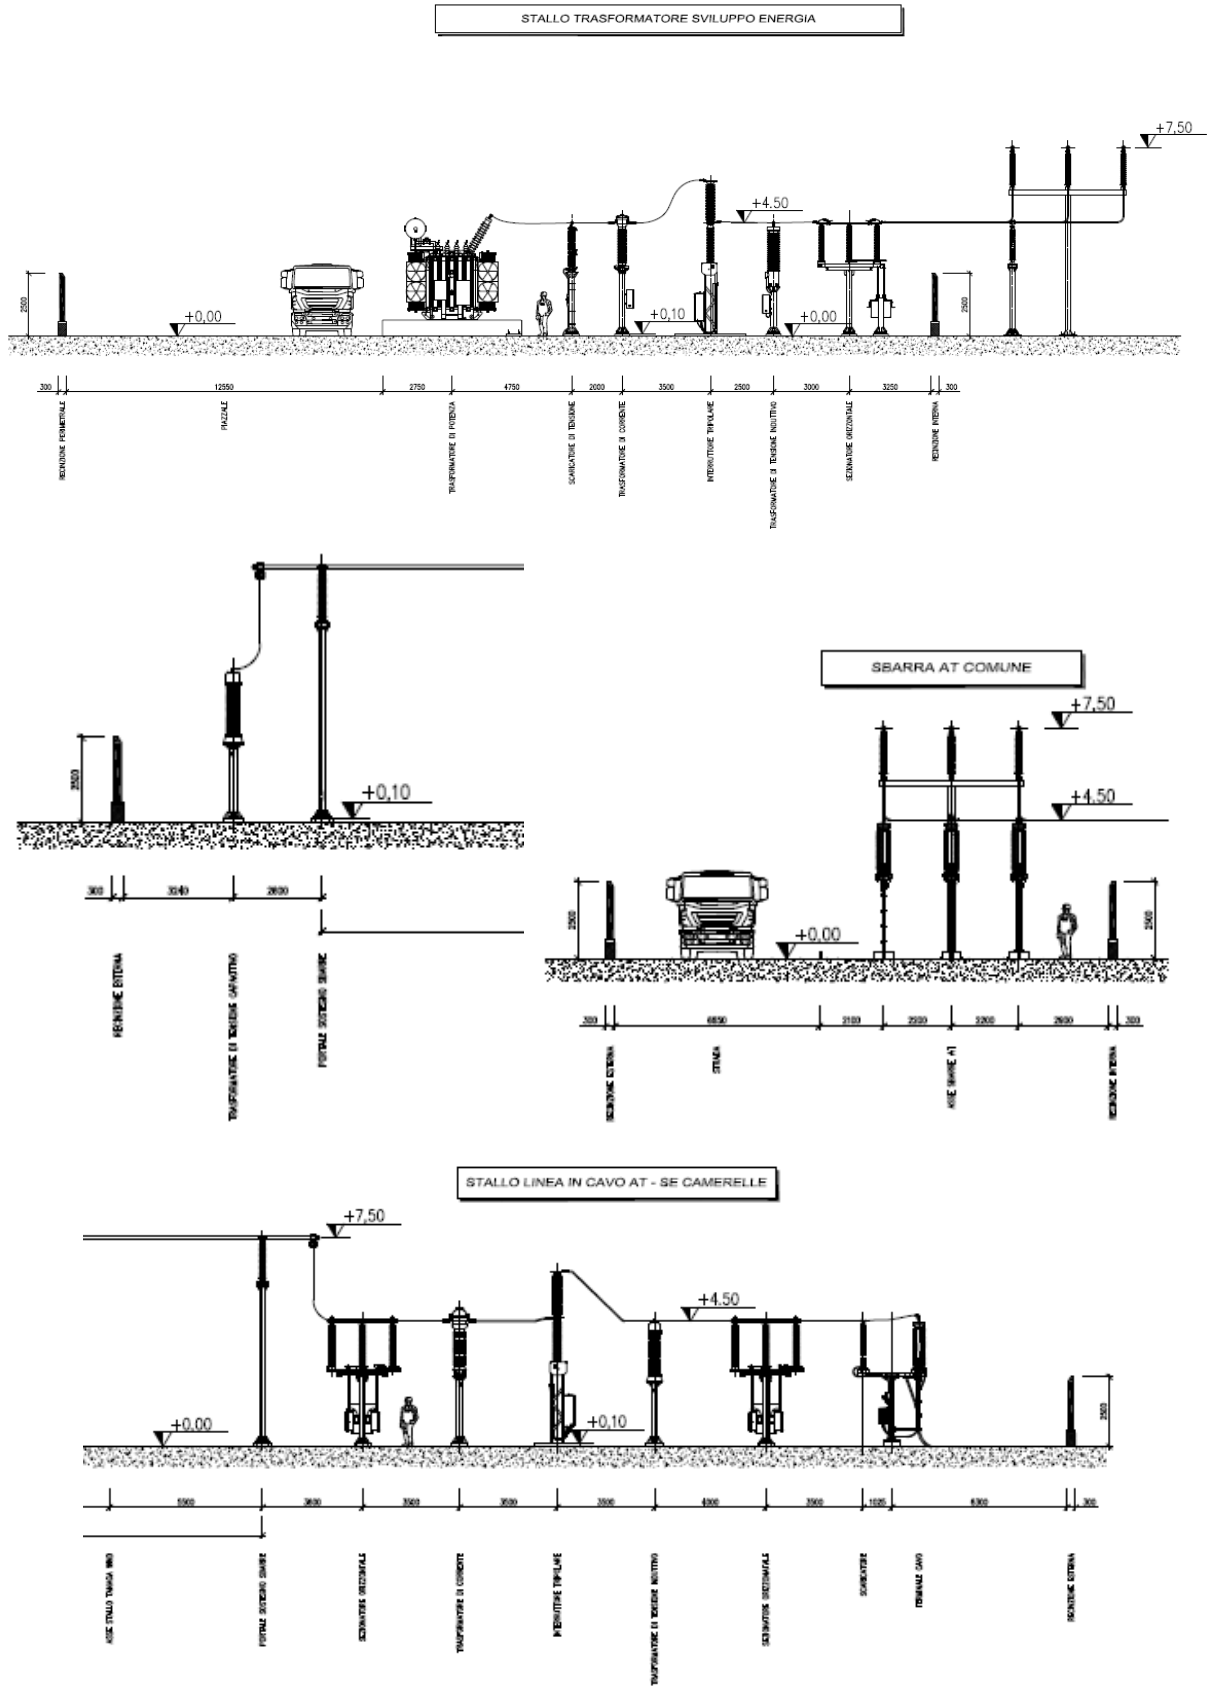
Sezioni del Punto di raccolta con individuazione delle altezze
